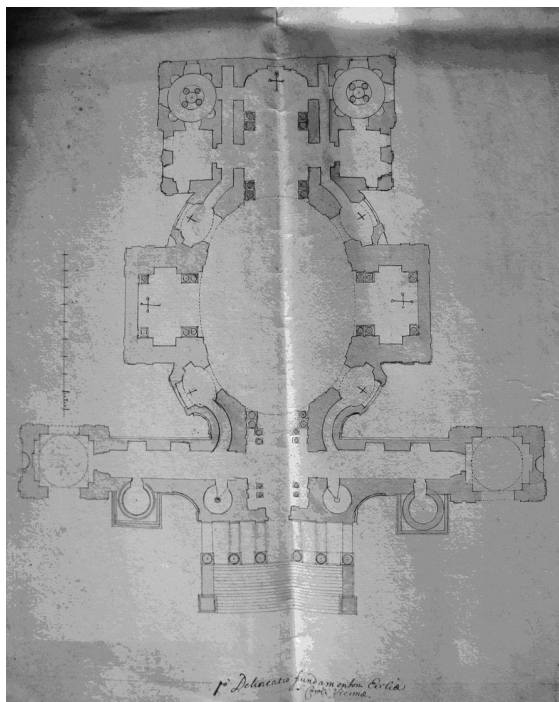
Grundriss der Karlskirche, Praha
